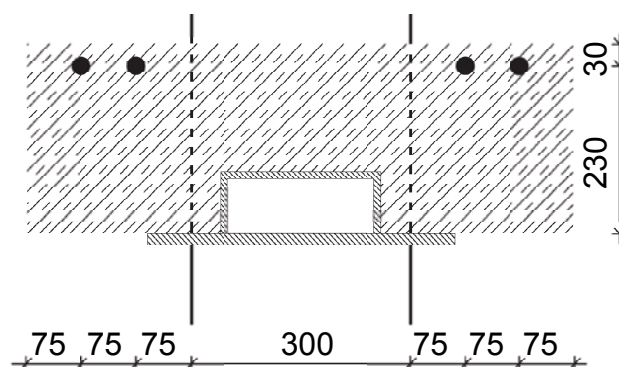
Mögliche Bewehrungsanordnung für Stützbewehrung
